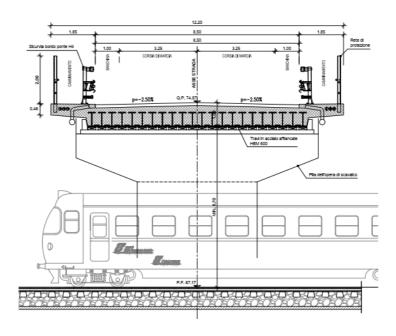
Cavalcaferrovia NW04 – Sezione trasversale impalcato (campata centrale)
